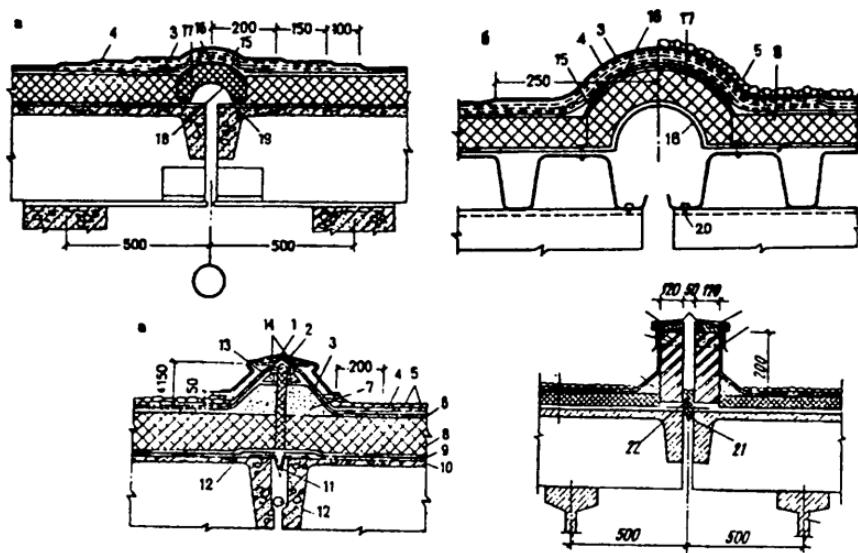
Температурные швы в покрытиях с рулонным гидроизоляционным ковром:
